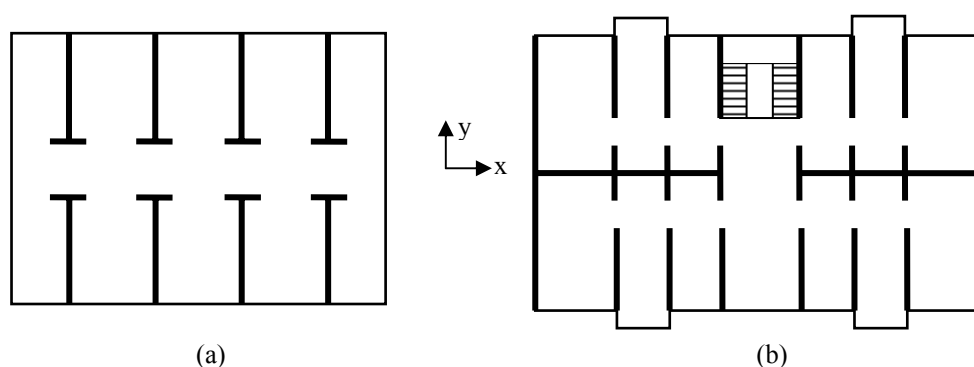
Distribución de los Muros Estructurales en el Plano.
